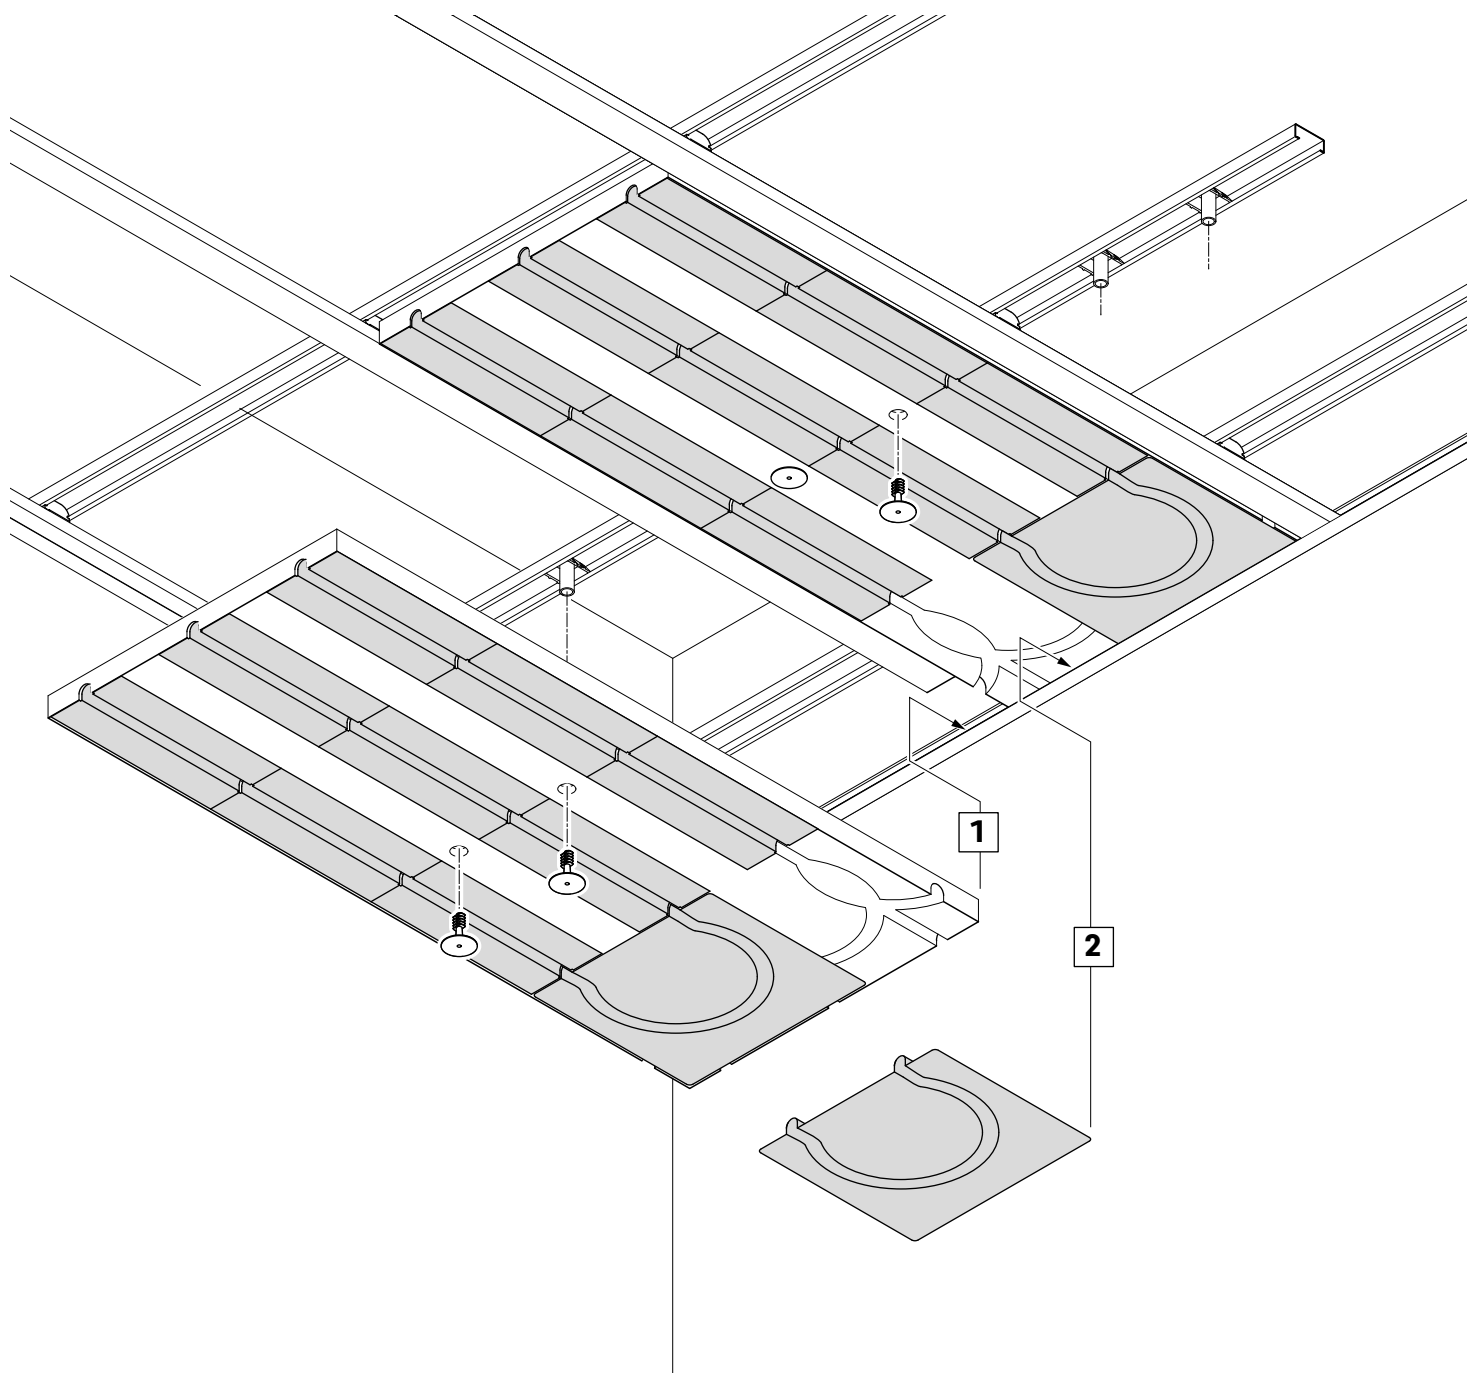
Pose des dalles d'extrémité RAUTOP, vue isométrique de dessous.
